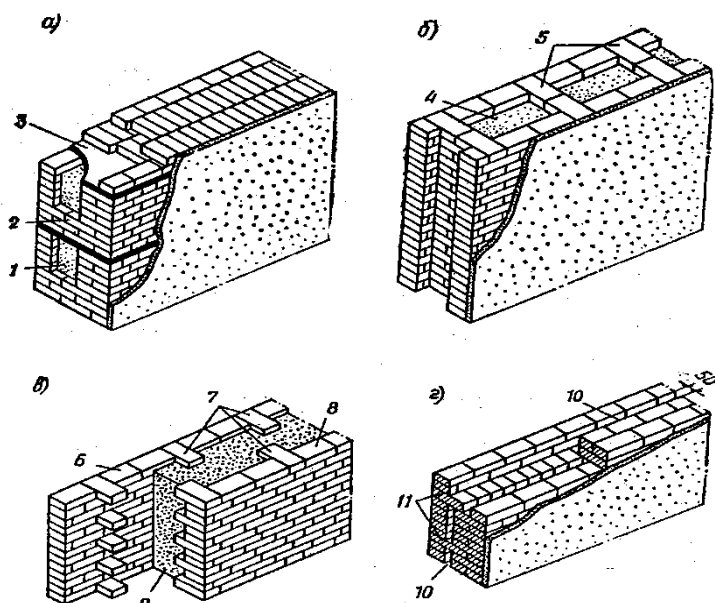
а – с трехрядными диафрагмами; б – колодцевые; в – анкерная кирпично-бетонная; г – с воздушной прослойкой; 1 – легкий бетон или другой утеплитель; 2 – диафрагма из трех рядов кладки; 3 – растворная стяжка; 4 – колодец, заполненный утепляющим материалом; 5 – вертикальная диафрагма из тычковых кирпичей; 6 – наружная верста; 7 – анкера из тычков кирпича; 8 – внутренняя верста; 9 – легкий бетон; 10 – воздушный зазор; 11 – перевязка тычками
